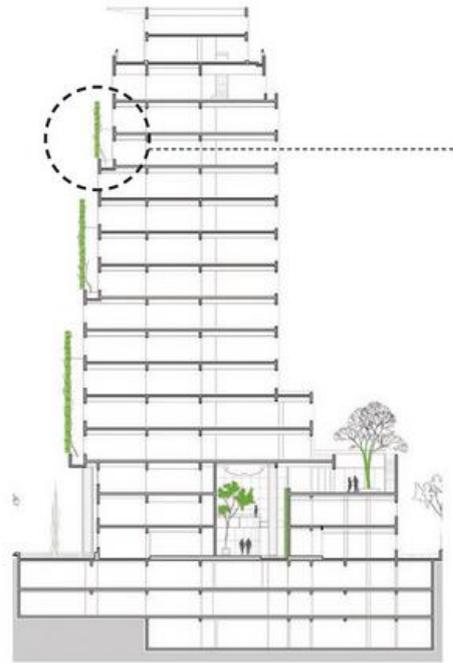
32 Potongan sistem green walls Consorcio Santiago
